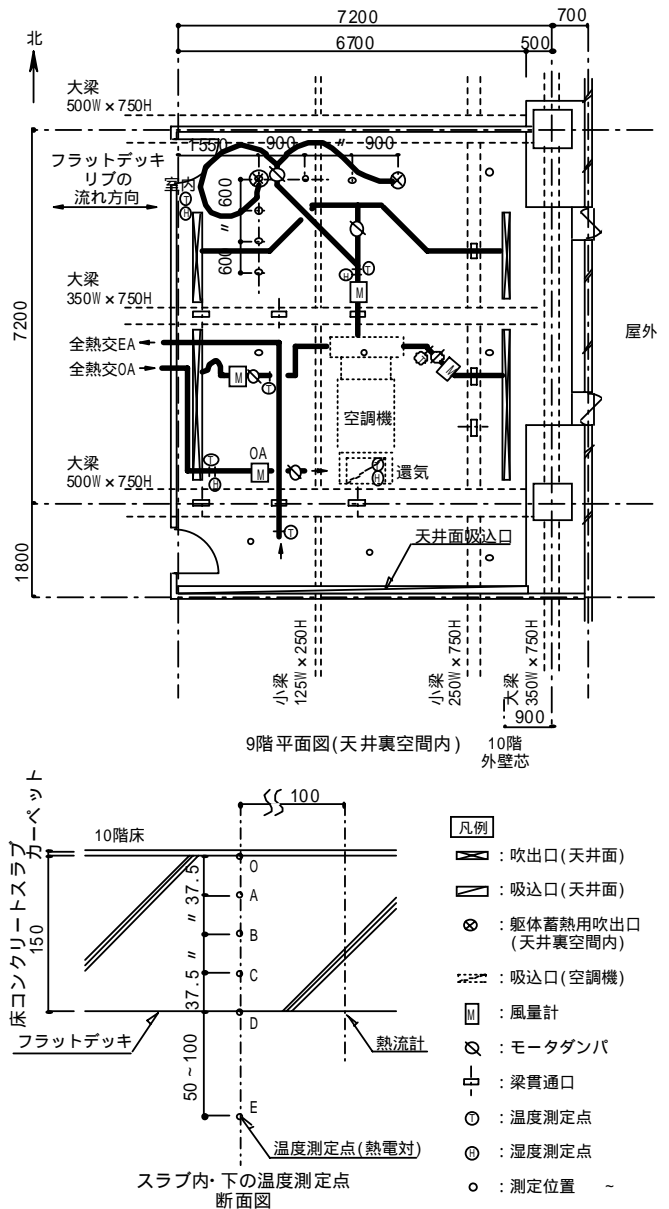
実測対象室の空調設備および測定点の平面・断面図
